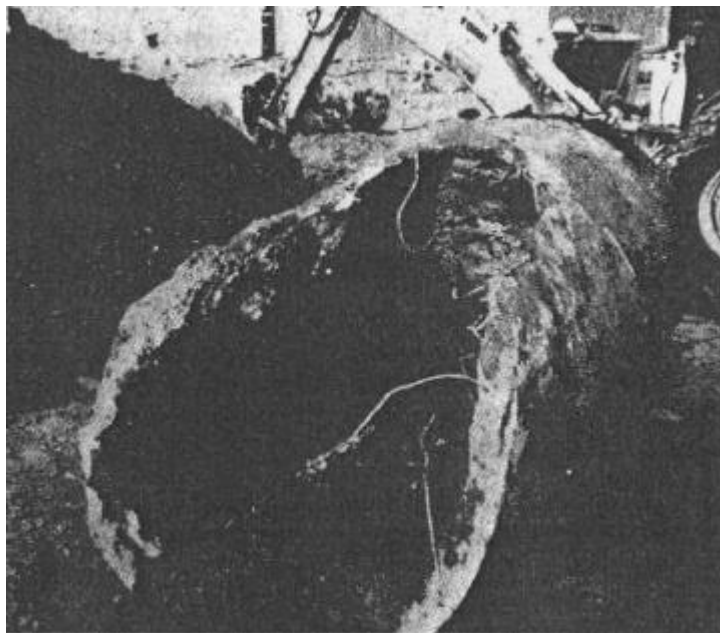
Tubería de concreto corroída (Basurto et al. 2012)
